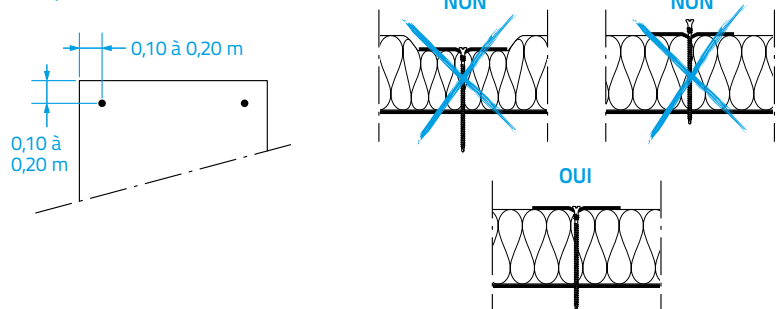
fixation des panneaux isolants (exemple d'un bâtiment de hauteur ≤ 20 m selon dispositions du DTU 43.3)
